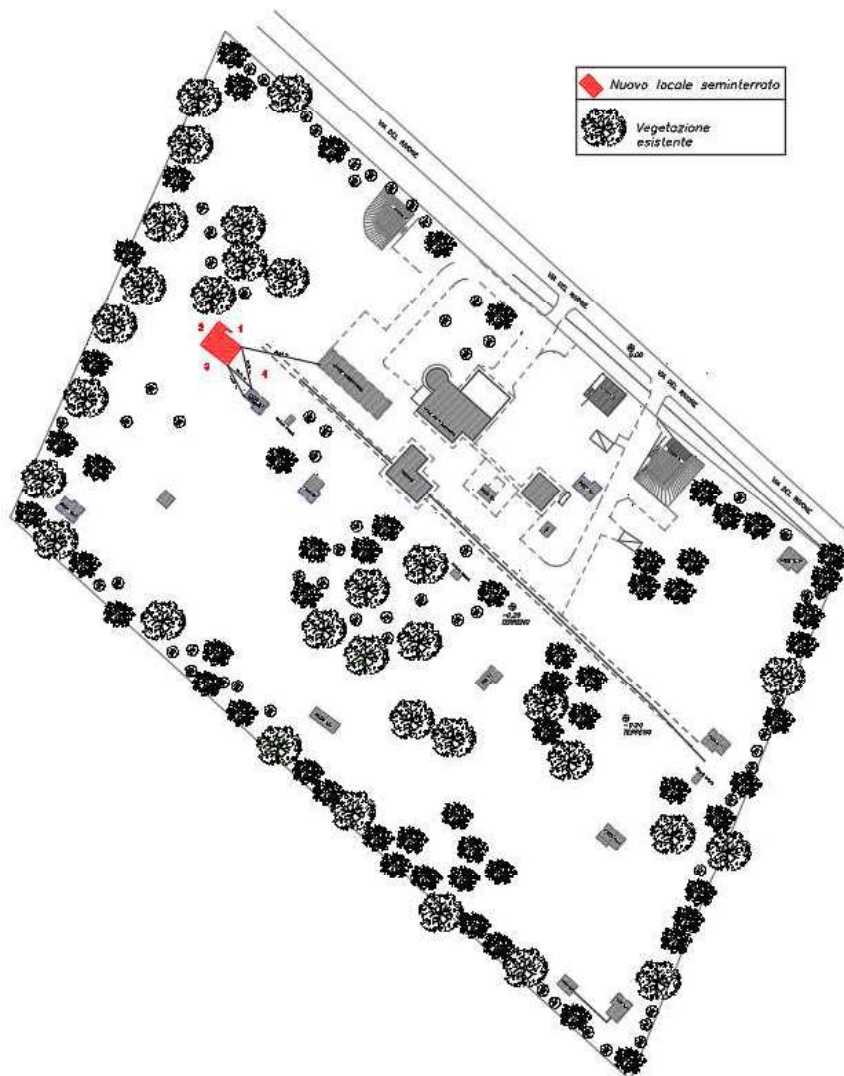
Planimetria complessiva del campo pozzi con evidenza del nuovo locale tecnico
